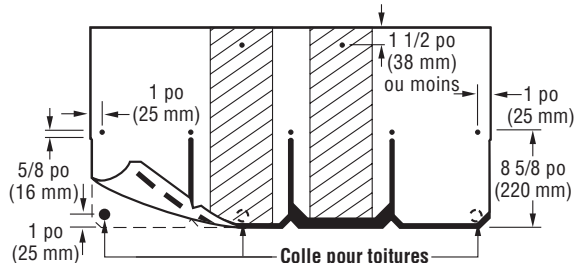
Lors de l'installation de Grand Manor sur des pentes raides, utilisez sept clous et trois points de ciment asphaltique pour toitures.
